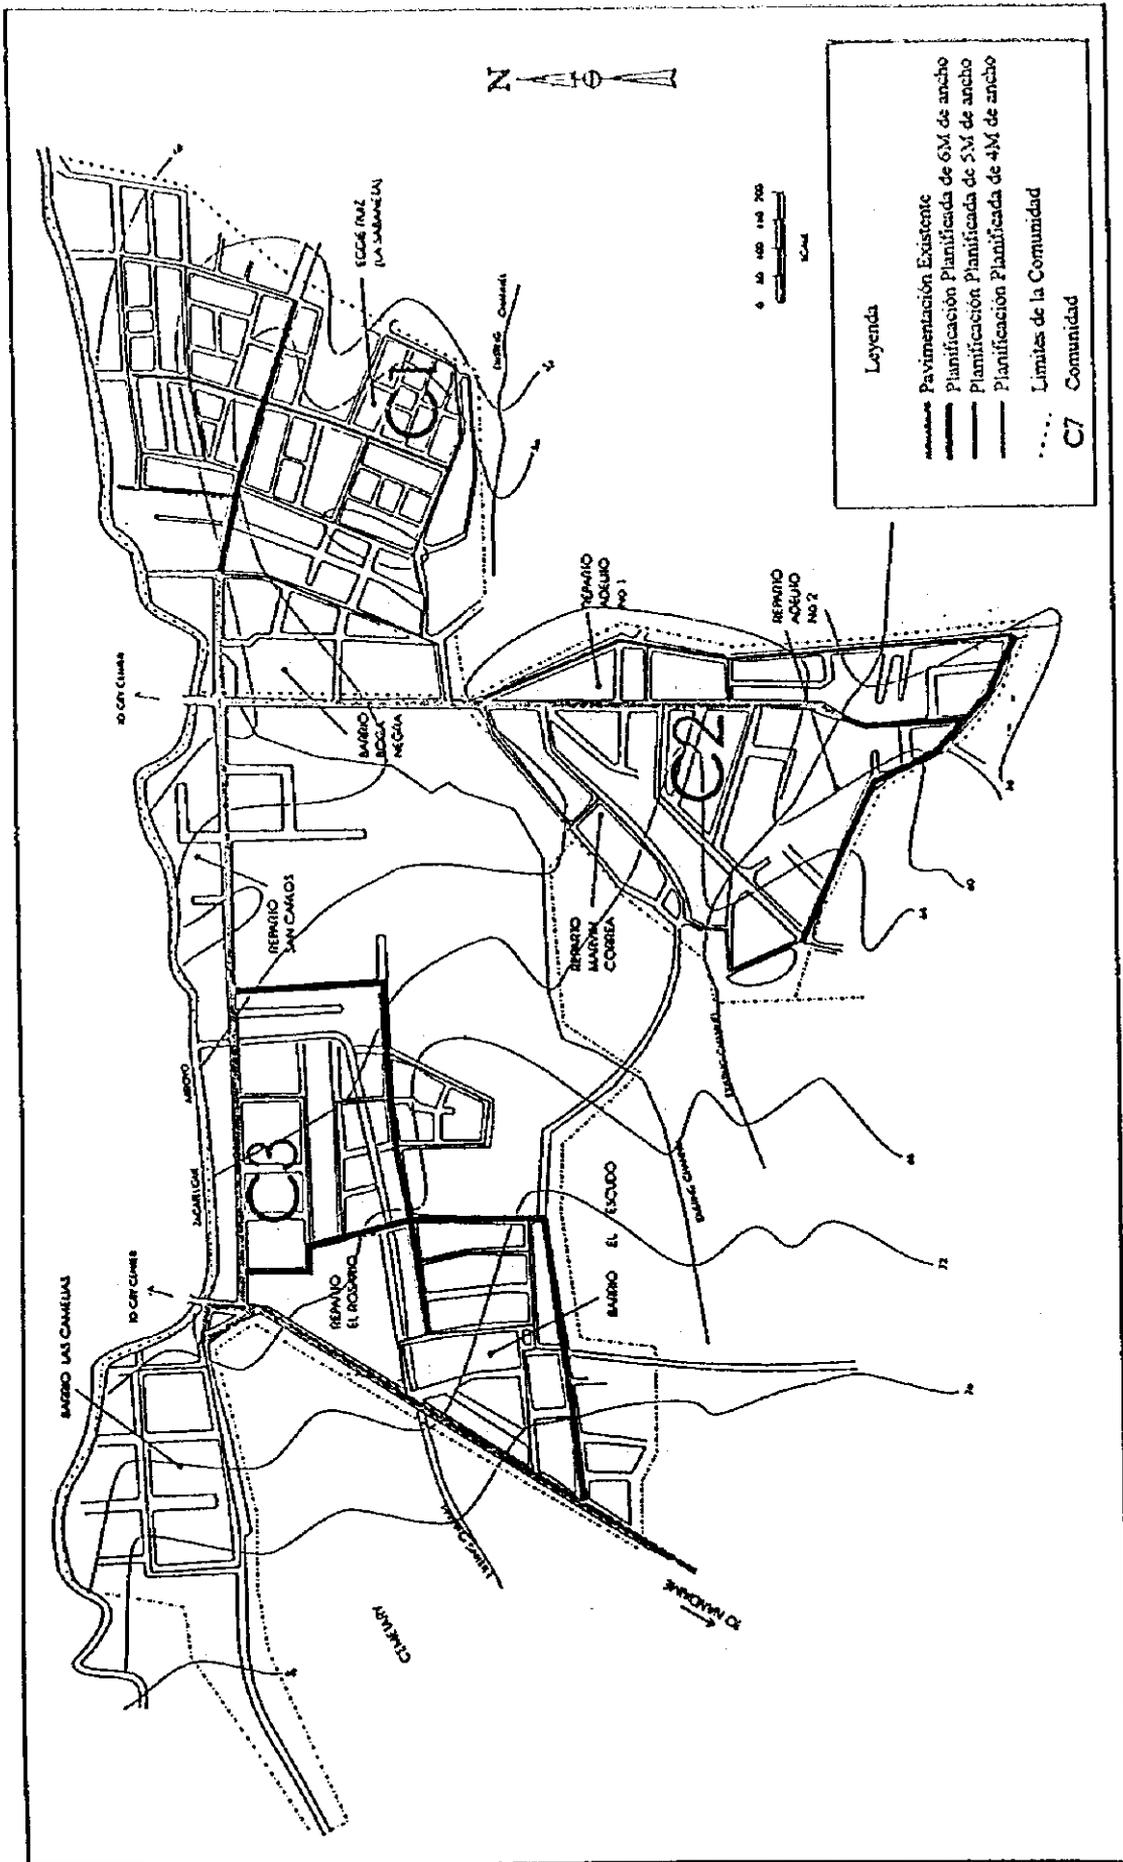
Proyecto para el Mejoramiento del Drenaje Pluvial (2)
